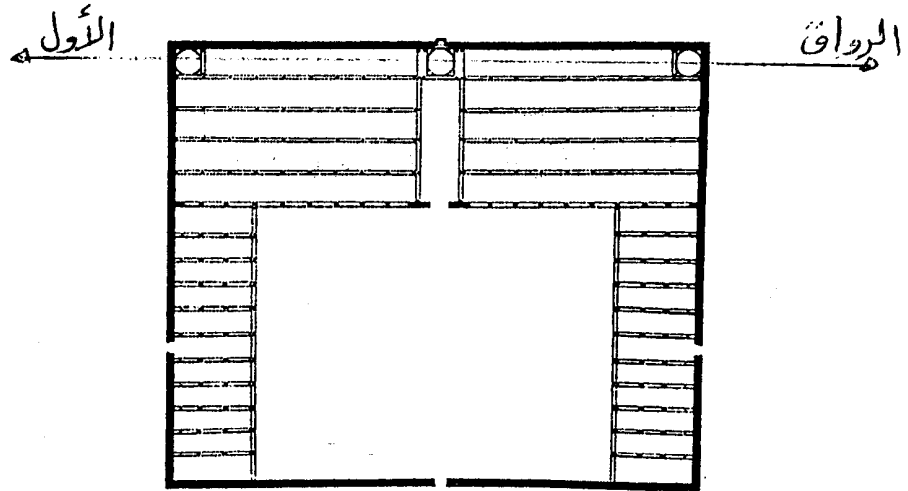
مسقط أفقي للجامع الكبير بصنعاء اليمن (عن : Creswell)
